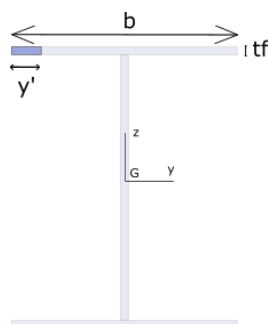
Coupe dans la semelle d'une section transversale en I
